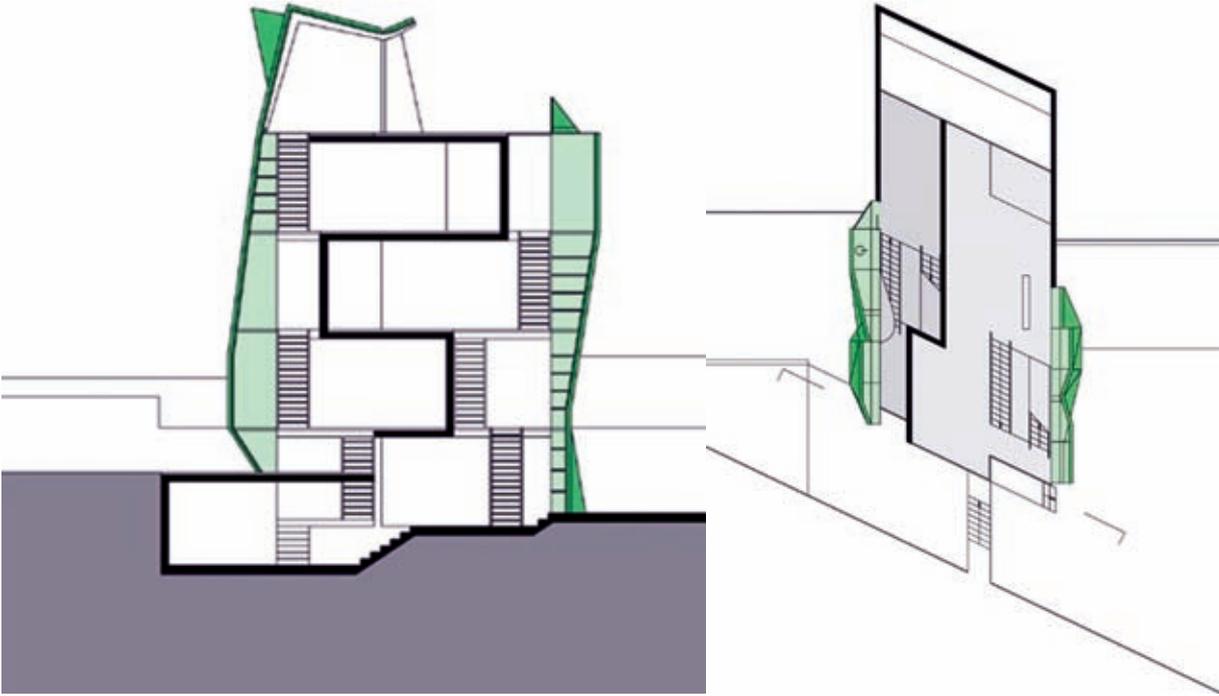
Schnitt und Grundriss Zweifamilienhaus „softbag house“, Wien
